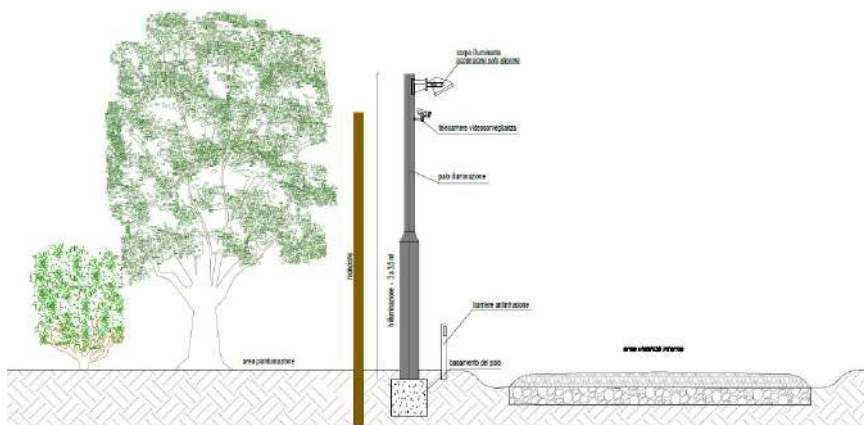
Sistema perimetrale: fascia piantumata - recinzione - illuminazione - viabilità interna
